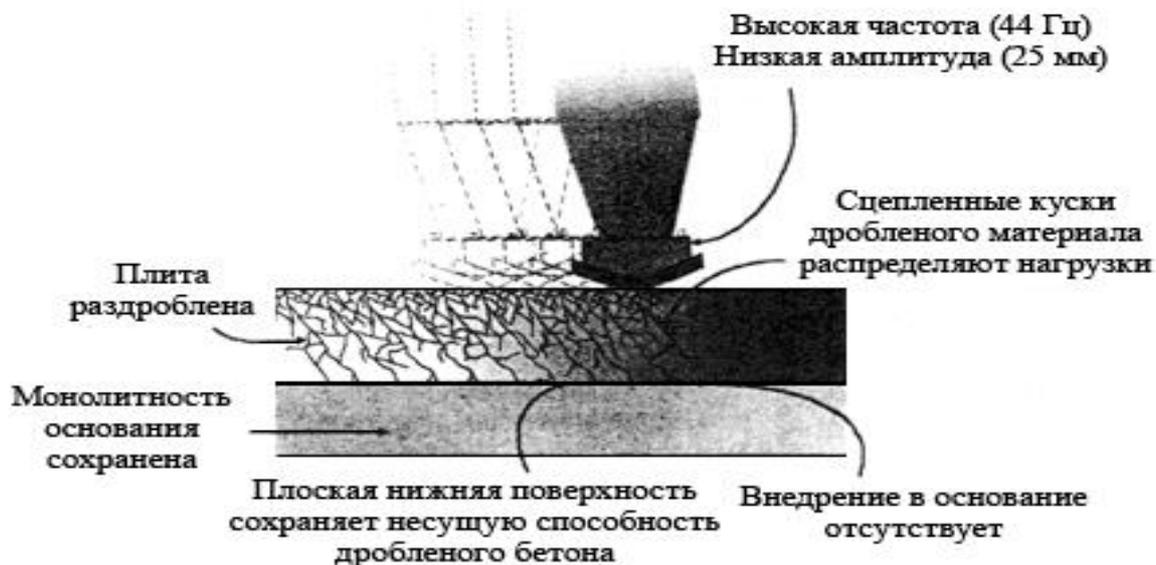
Схема разрушения покрытия резонансным бетоноломом.
